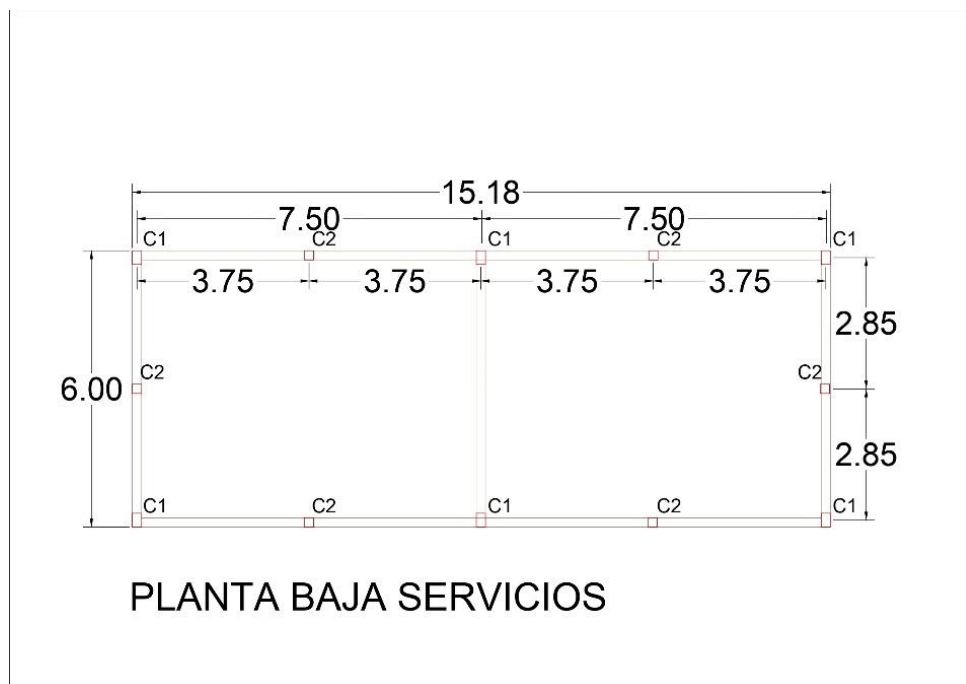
Estructura Planta Baja Servicios. Fuente: Elaboración propia.
